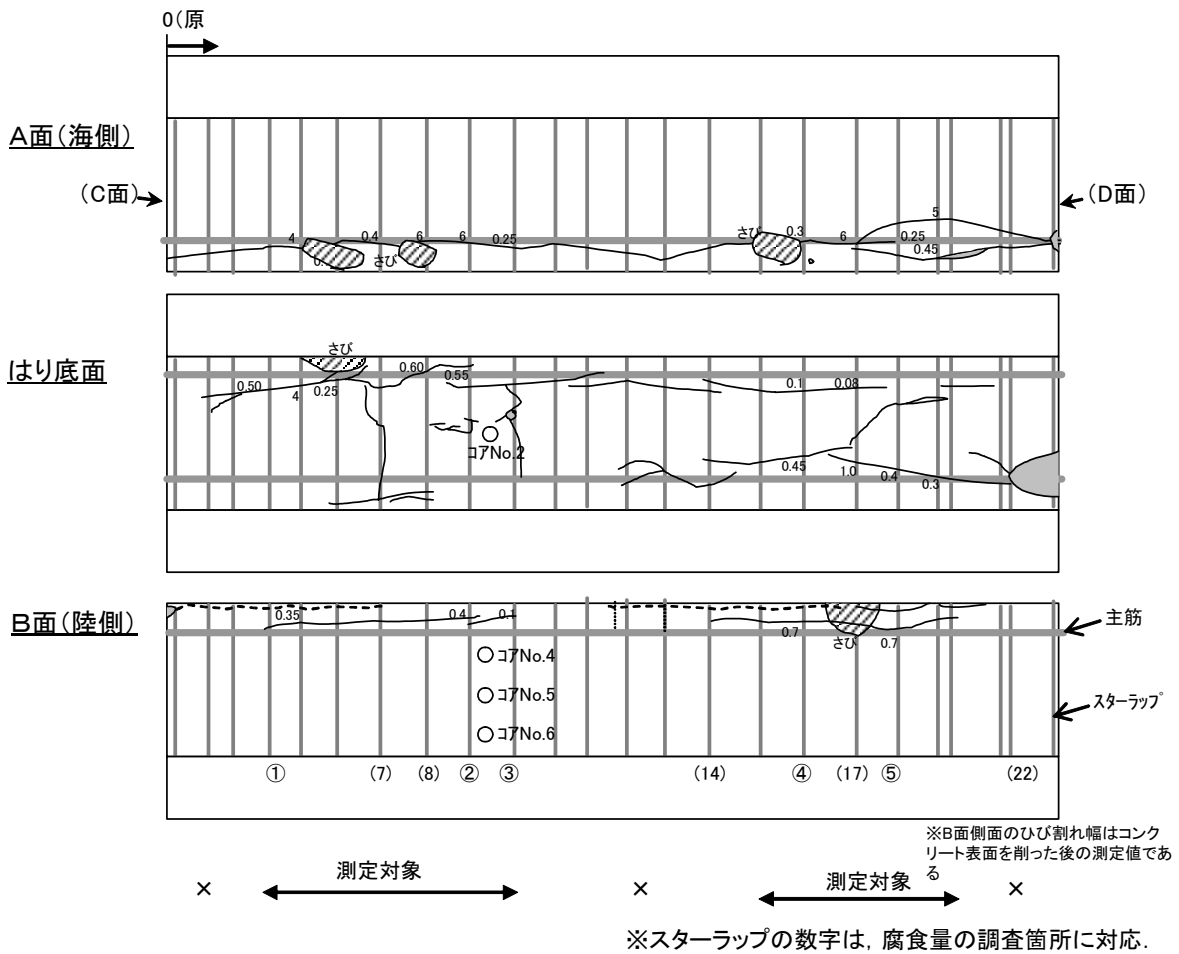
劣化状況、鉄筋およびコア採取位置
